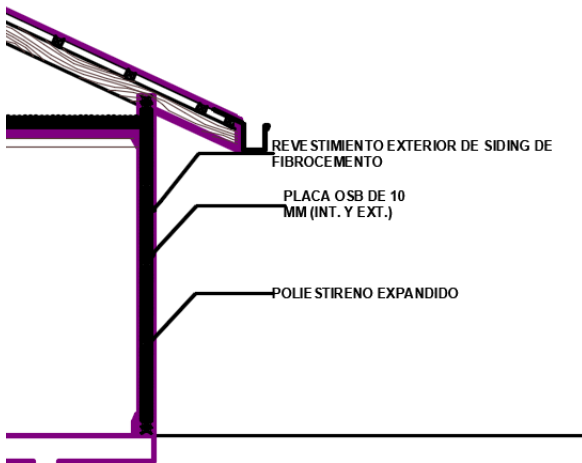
Zona 1 de muros. Extracto de planos existentes.
